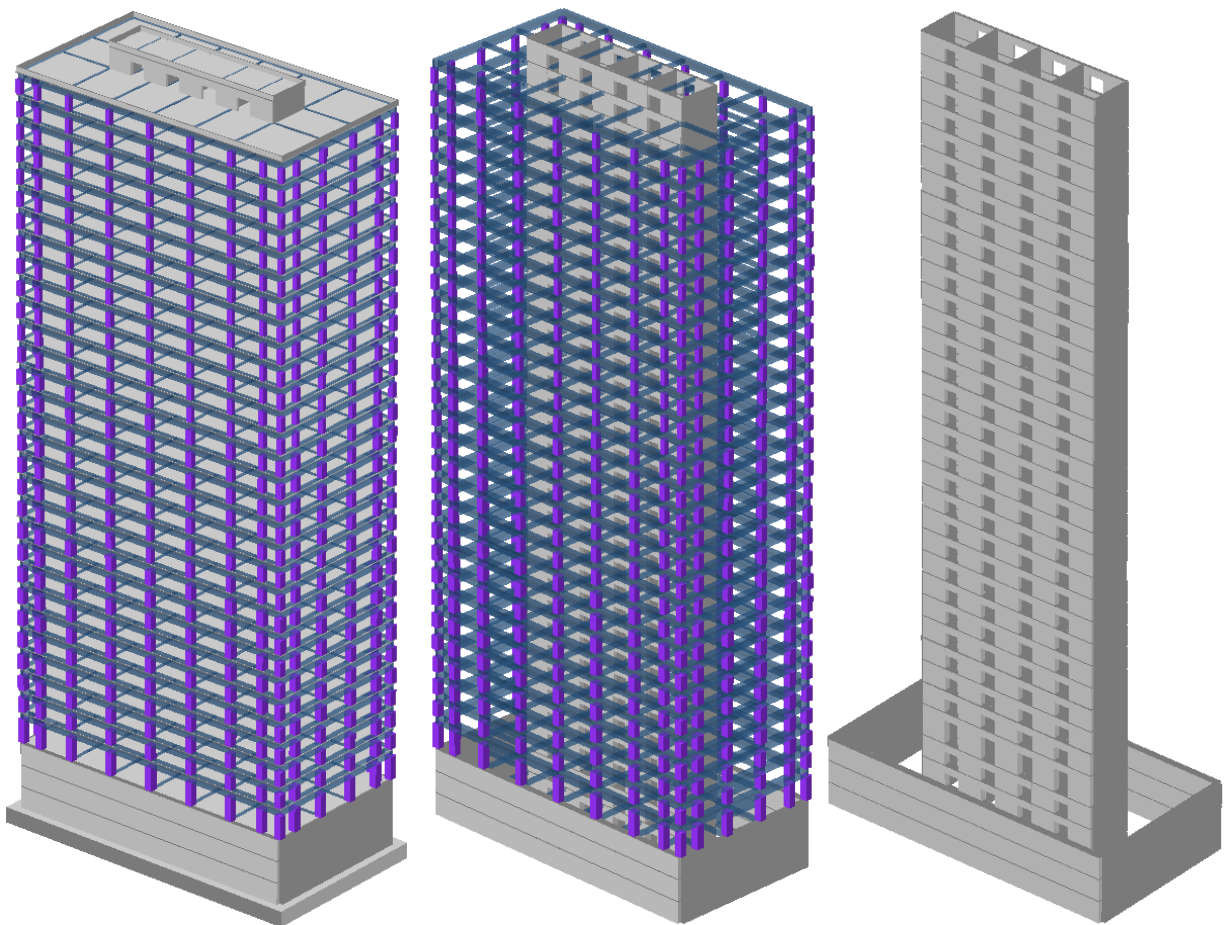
Расчетная модель здания и ее фрагменты.
